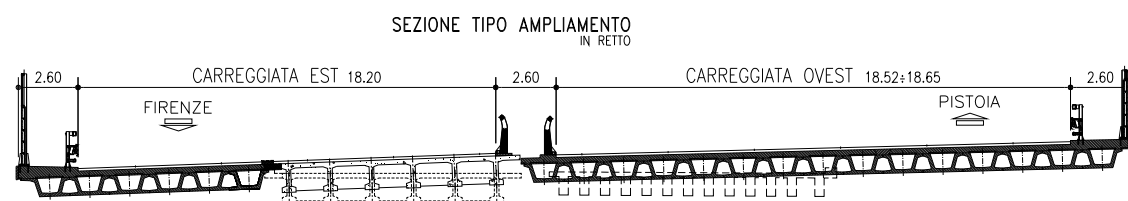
Sezione trasversale impalcato in ampliamento
